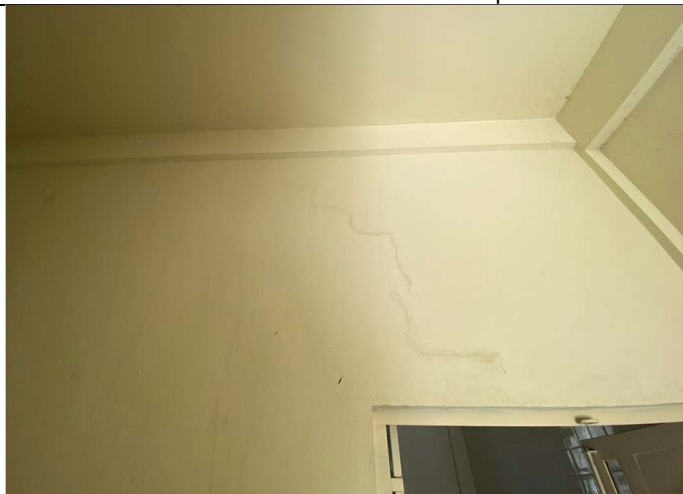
Sinais de trincas e infiltração em parede
